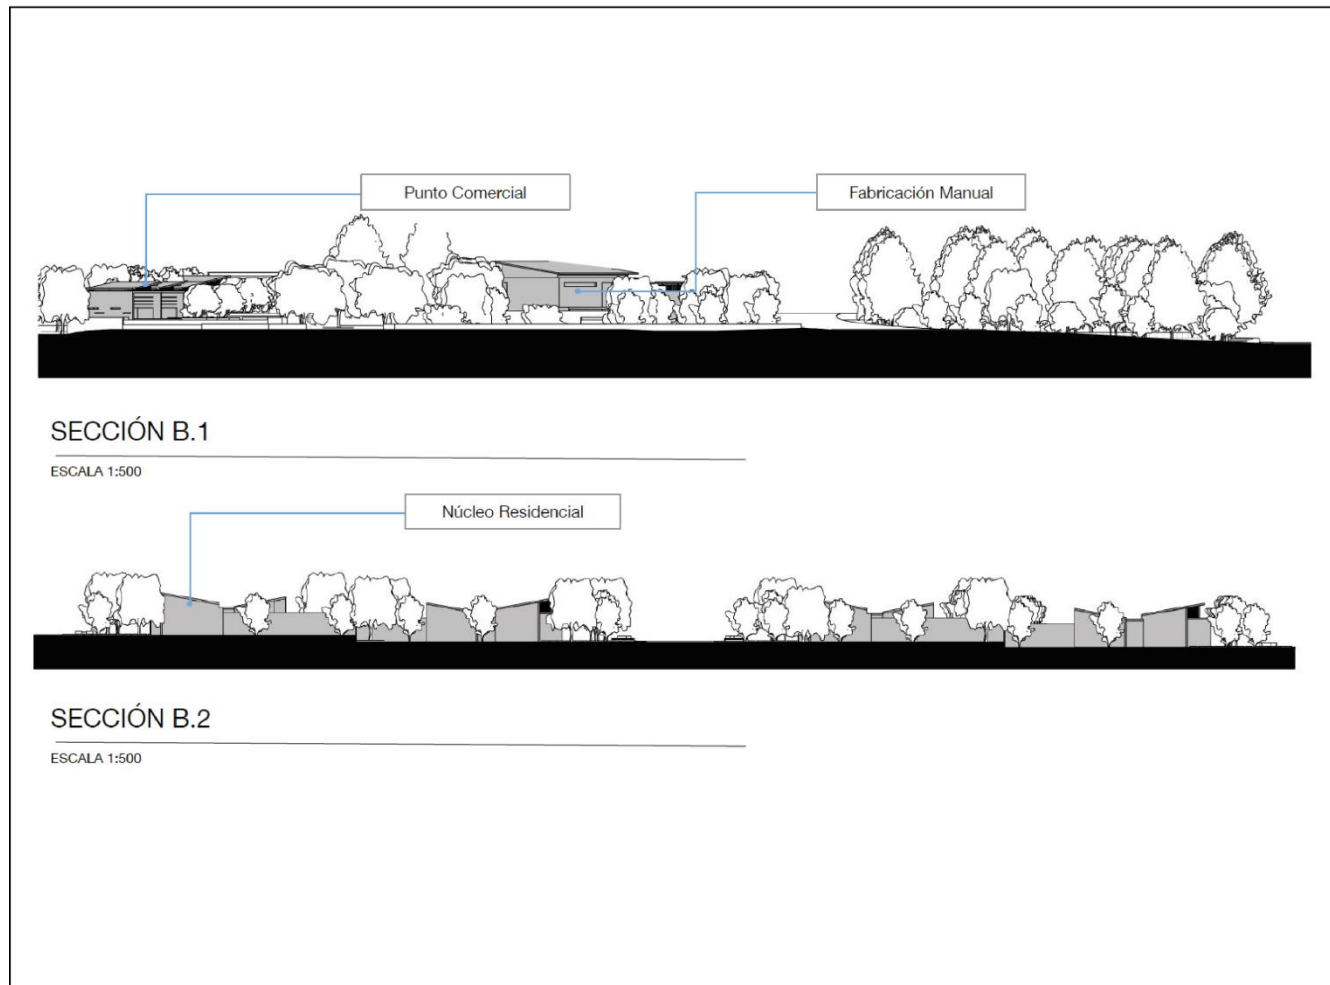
Sección B de conjunto. Chaves, J. (2019).
